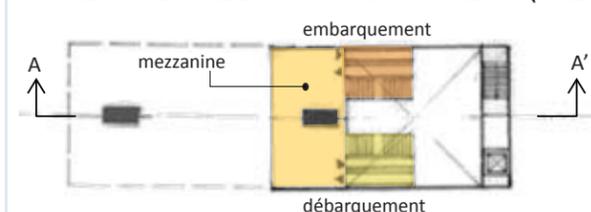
PLAN DE LA STATION MONTMORENCY (NIVEAU RDC+2)
